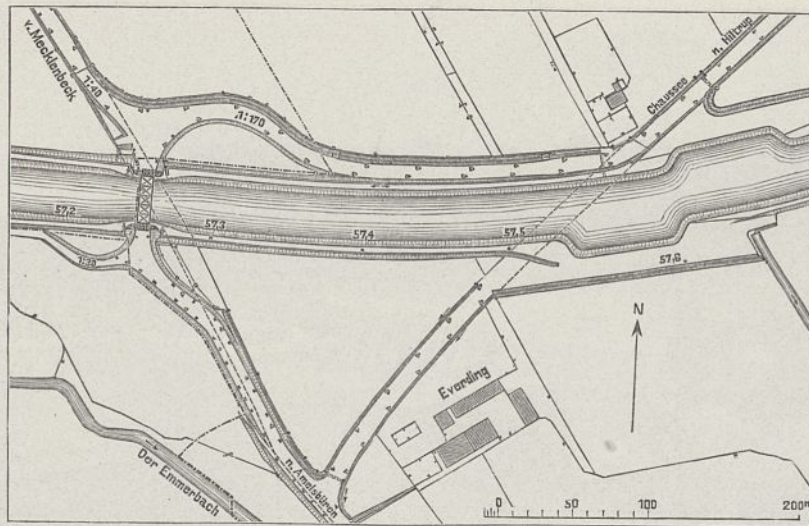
Lageplan der Chausseebrücke bei Amelsbüren Kil. 57,25.
